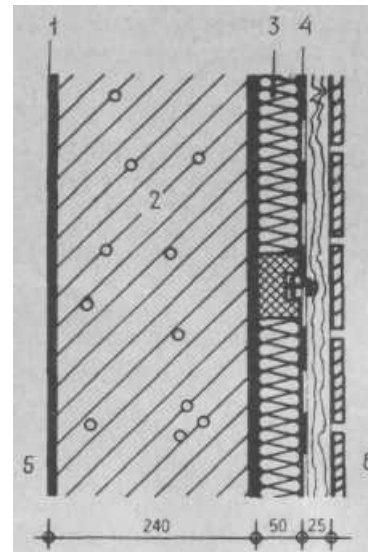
Железобетонная стена с внутренней теплоизоляцией из пенополиуритана и паронепроницаемой алюминиевой пленкой
